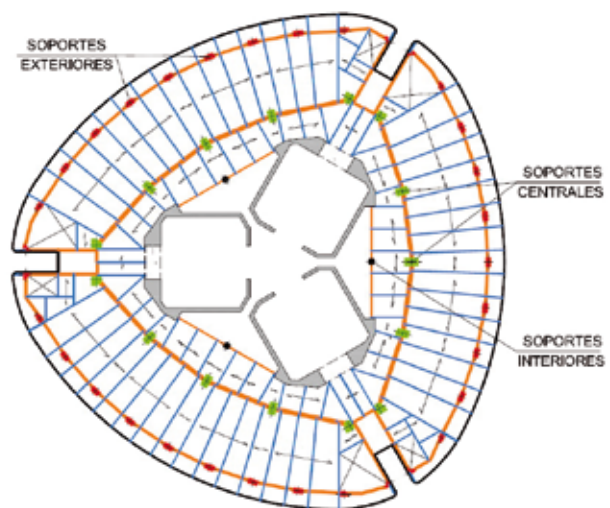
Disposición de soportes, vigas y viguetas en la planta
